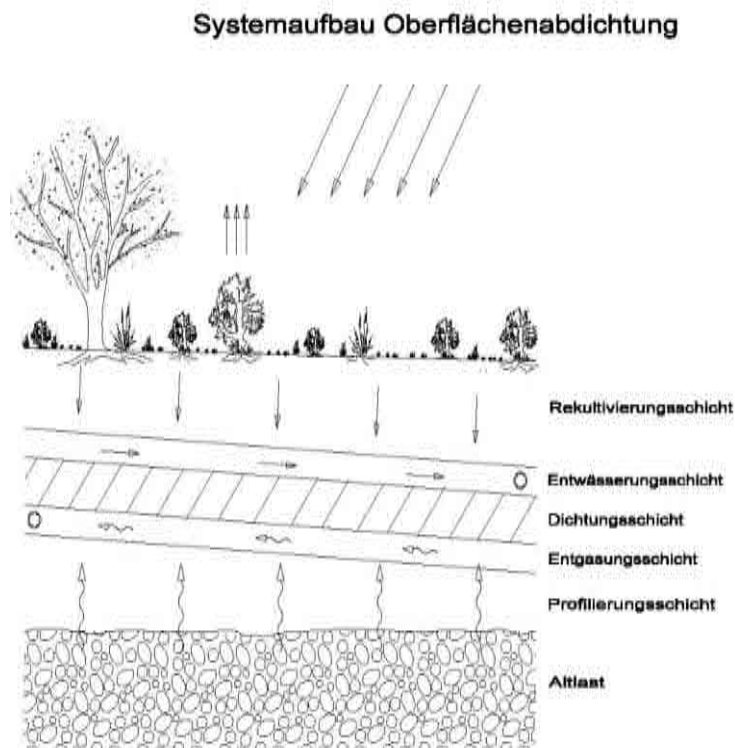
Systemaufbau Oberflächenabdichtung
